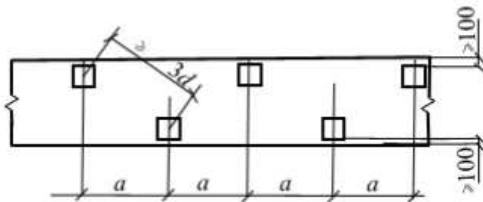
Схема расположения свай в рядовом фундаменте
